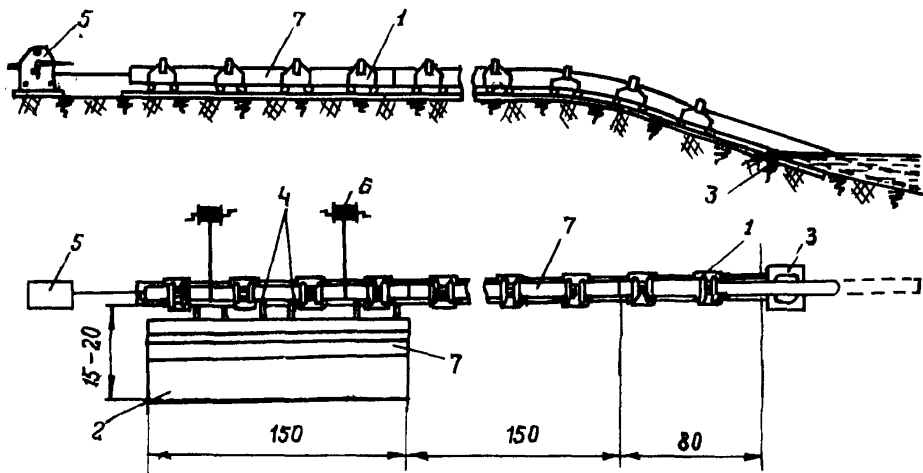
Схема роликовой спусковой дорожки для укладки трубопровода диаметрами 1220,1420 мм:
